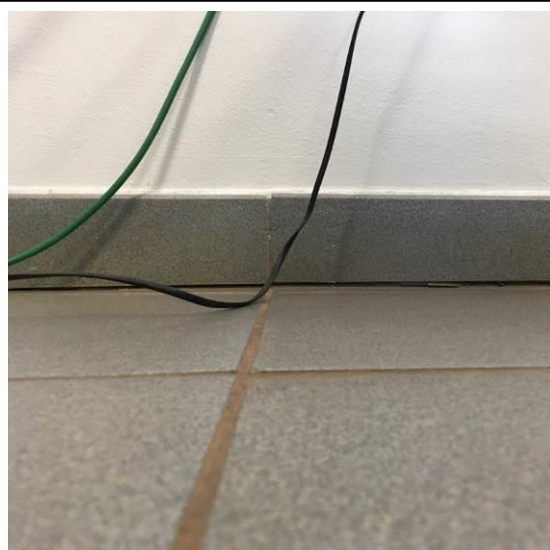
Bâtiment A R+1, bureau 17 - Plancher : D2 – Déformation modérée.
